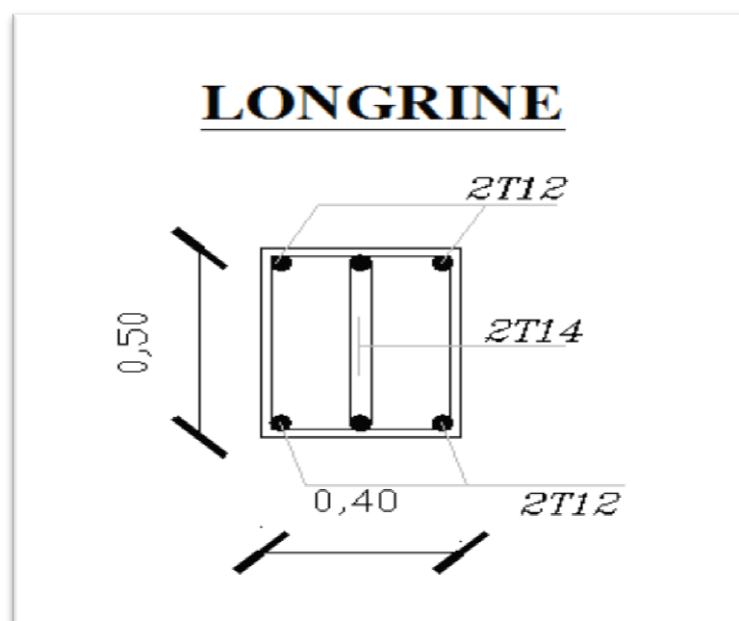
Schéma de ferrailage de longrine.VI.3. Etude du voile périphérique :VI.3.1. Dimensionnement:
